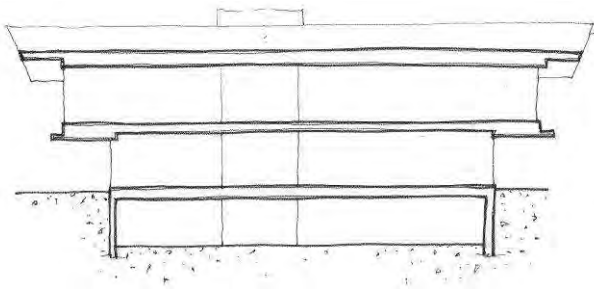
Esquema estructural para resolver el gran voladizo de la casa Robie, mediante dos potentes vigas metálicas de sección doble "T" que acompañan la línea de carga de la cubierta. Las vigas quedan embebidas ocultas entre el falso techo y la cubierta.
